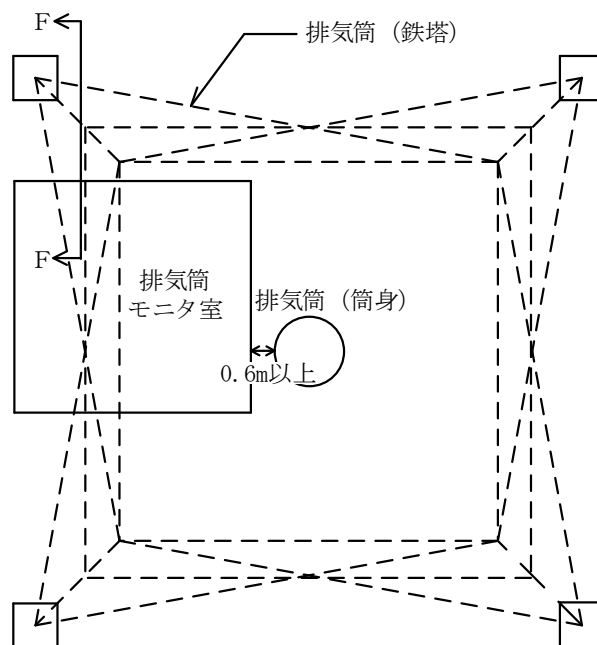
(2) 建物配置図 (排気筒モニタ室及び排気筒の詳細)
